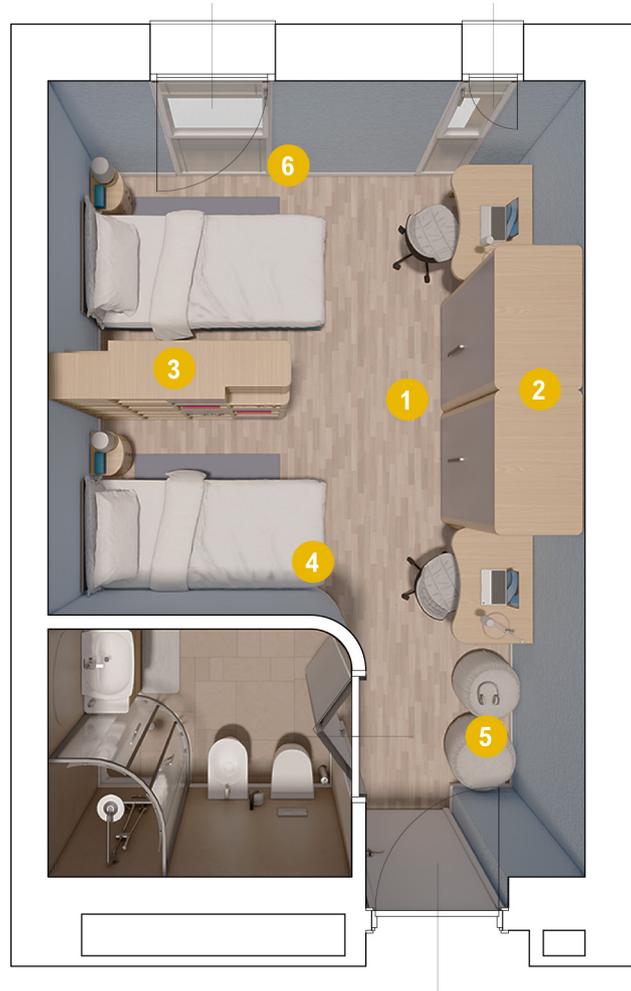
Render, vista camera da letto doppia con libreria-filtro.
